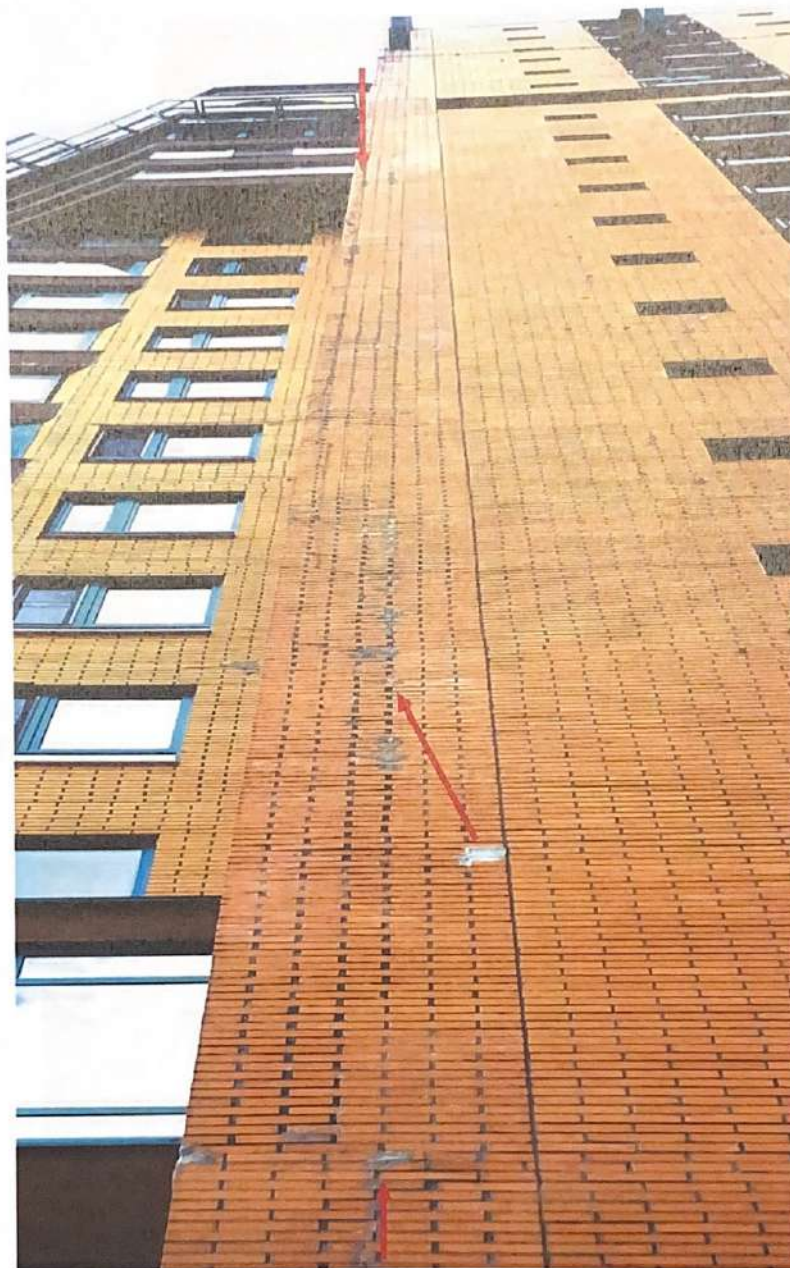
Секция 12. Фасад 2. Трансэтажные вертикальные трещины по левой стороне подъездного выступа. Раскрытие трещин на участках ранее выполненных ремонтов.
